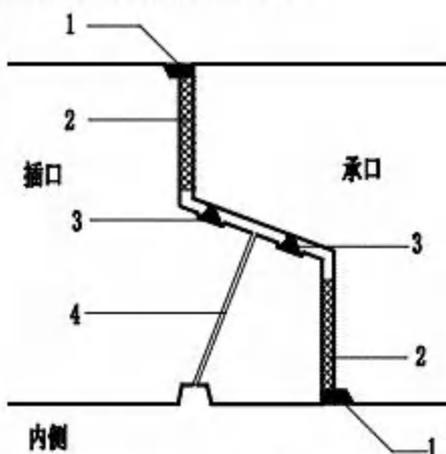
双胶圈柔性承插接头密封防水构造
